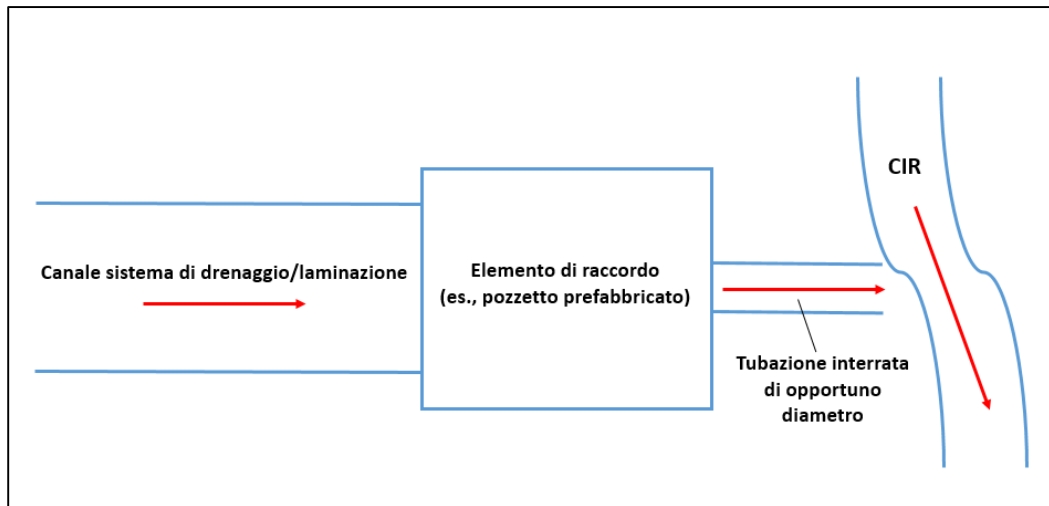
Collegamento fra sistema di drenaggio/laminazione e CIR – schema esemplificativo tipo 1 (vista planimetrica)
